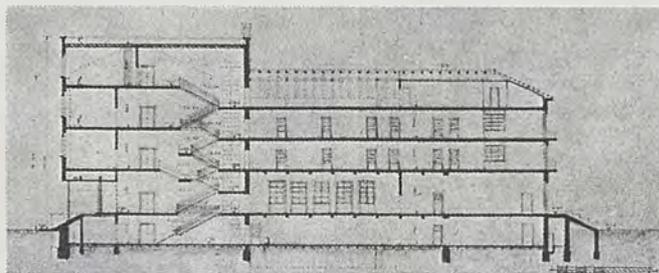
b - Convitto Biellese - I progetto: sezione longitudinale.
